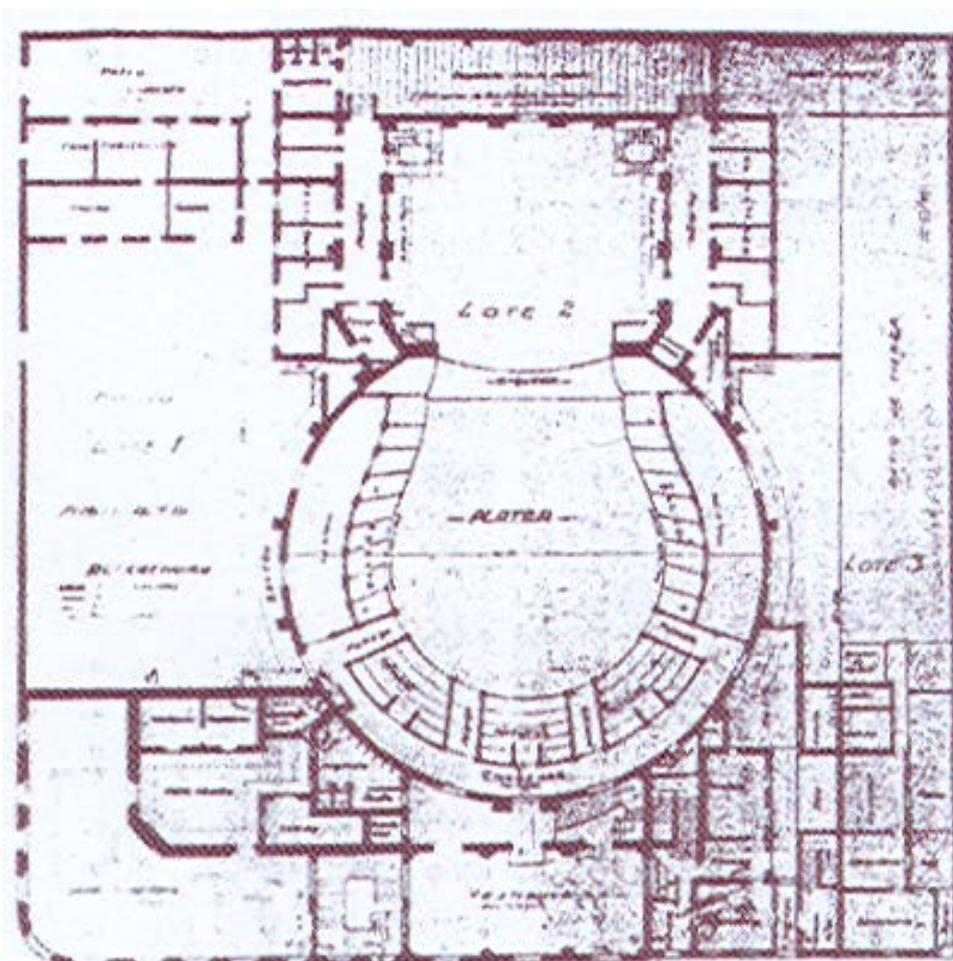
Teatro Coliseo Podestá. Plano de planta original del teatro. Calle 10 N° 741. La Plata
